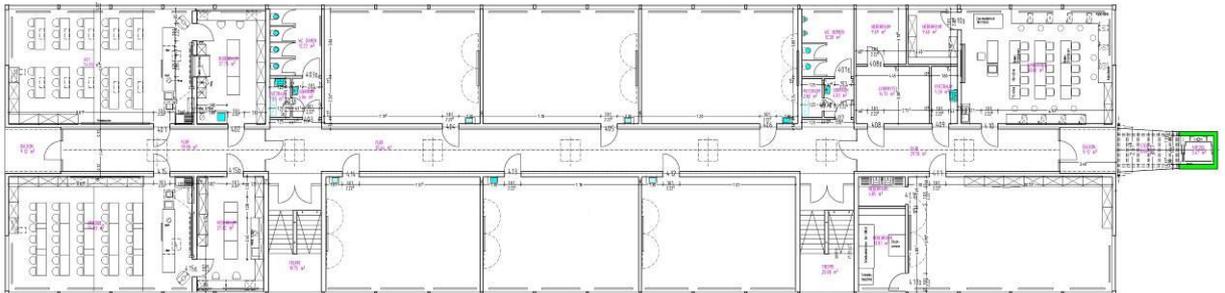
Grundriss des Dachgeschosses der Erich-Kästner-Realschule mit 4 Fachräumen und 6 Klassenzimmern.
